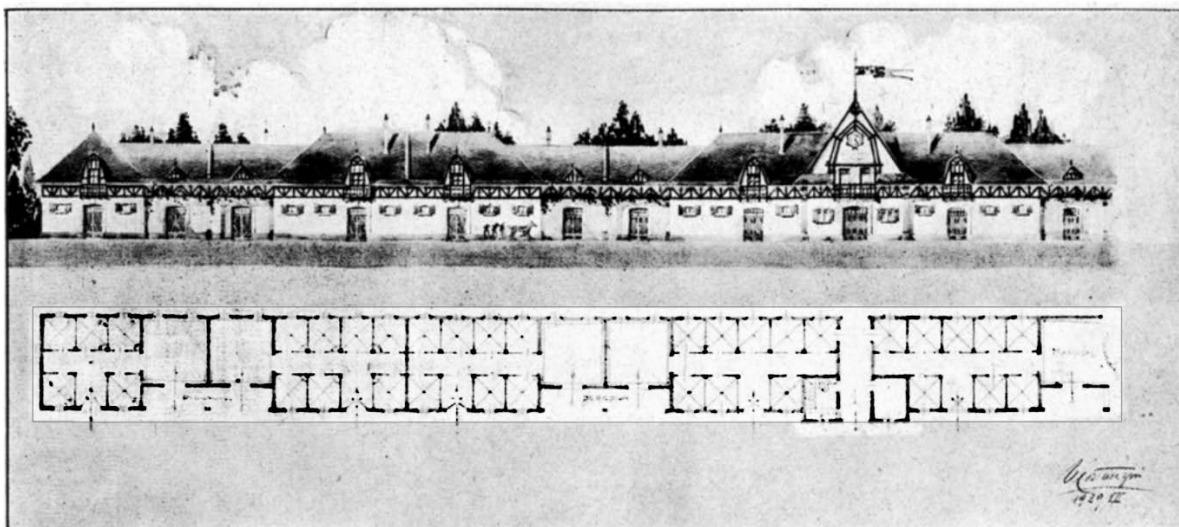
Planimetria e Prospetto della Scuderia - [rivista mensile Lo sport fascista n.10 ottobre 1929]
